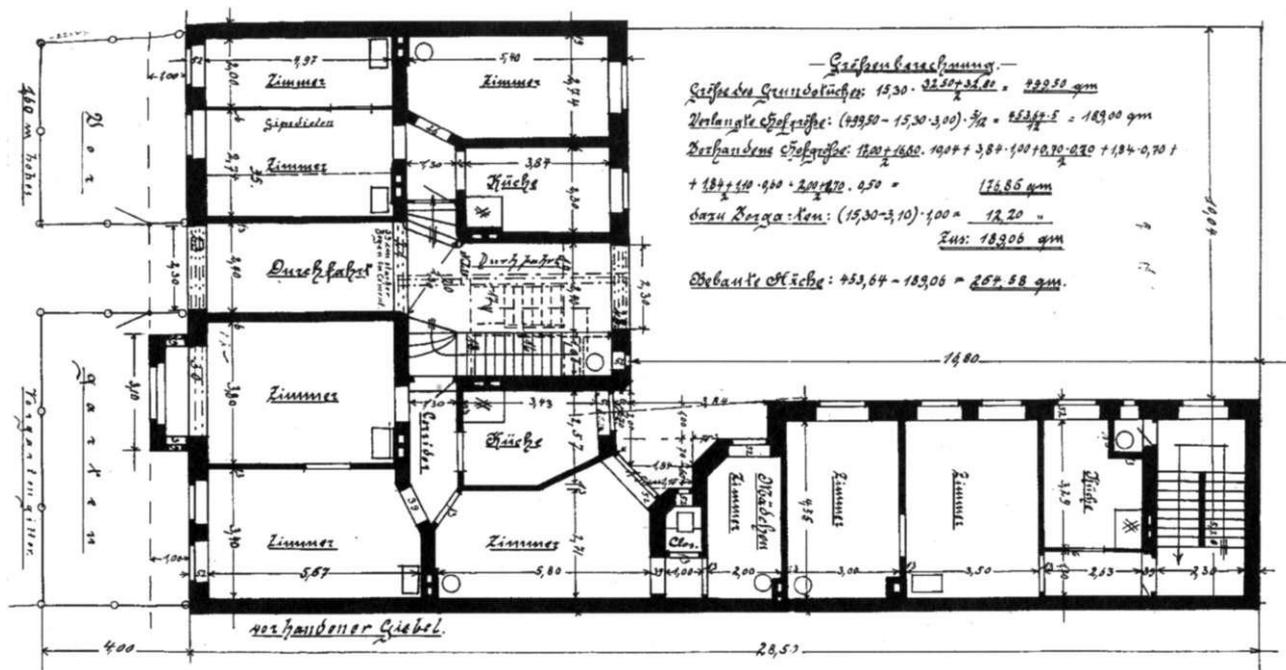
Grundrißtyp C, Winkelmannstraße 7, Erdgeschoß
